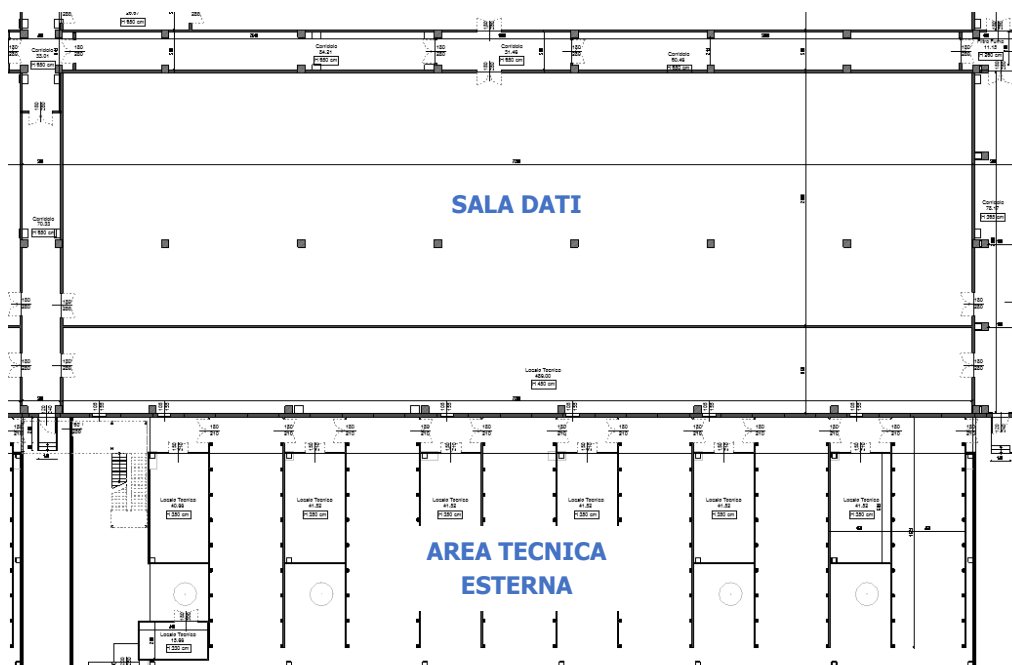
Stralcio pianta piano terra zona "sala dati" – stato di progetto
